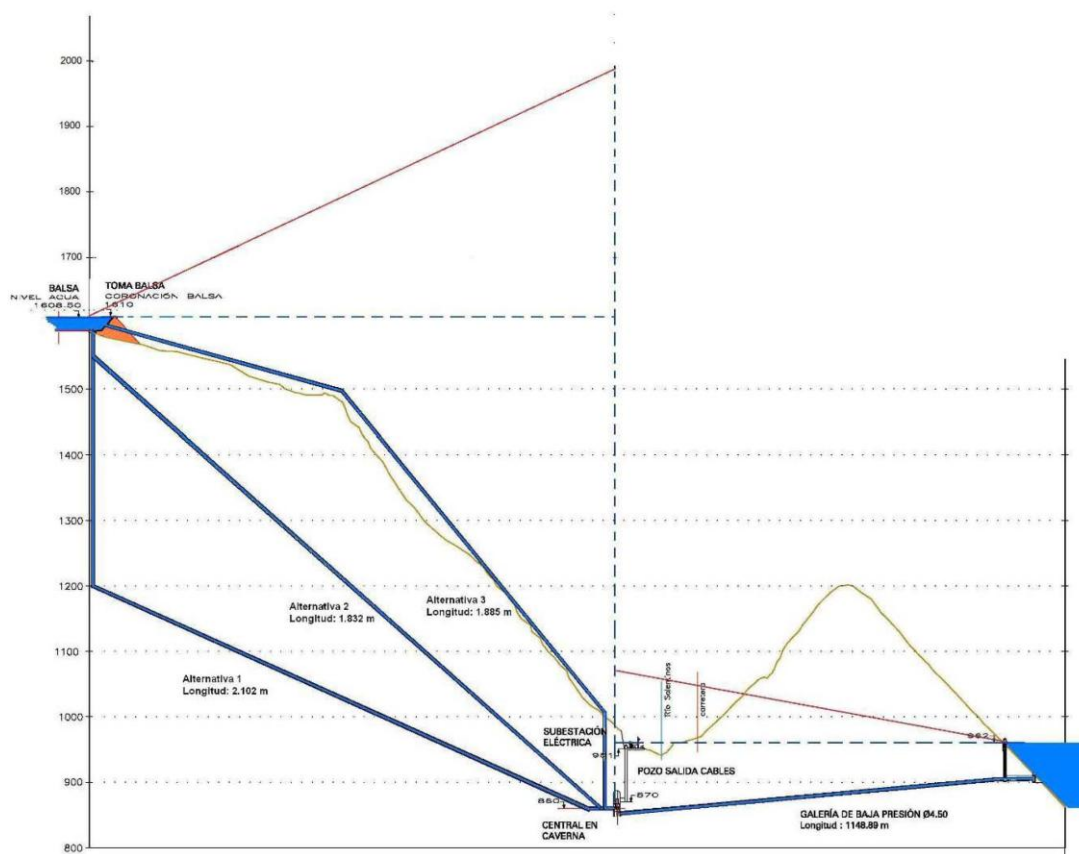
Esquema de alternativas para el trazado en perfil de la tubería
